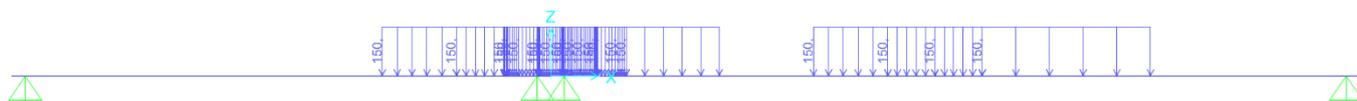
disposizione di carico 1 - SW/2 – pila 3
